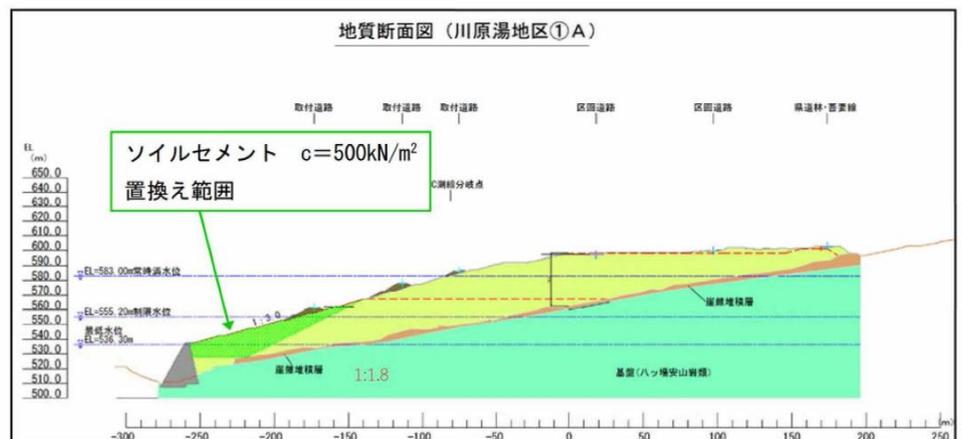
川原湯地区①ソイルセメント置換え 横断面図
